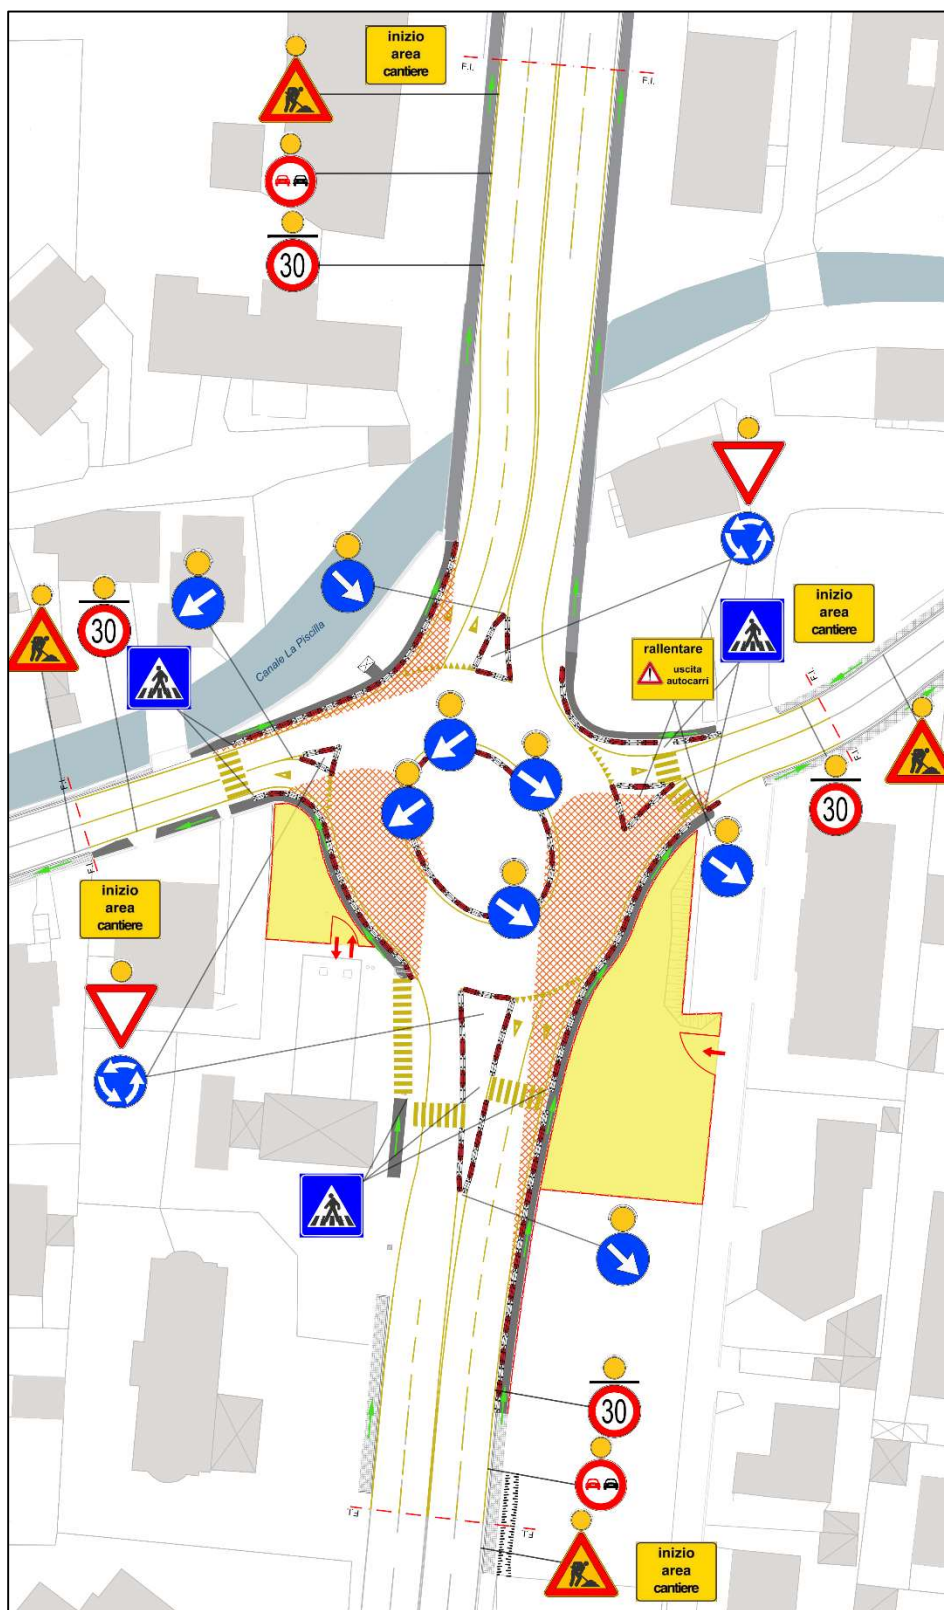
Stralcio planimetria Cantierizzazione (Fase 3)
